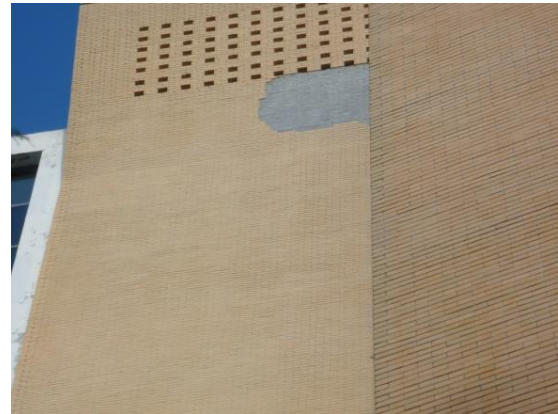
Exemplos de anomalias em paredes de tijolo face à vista
